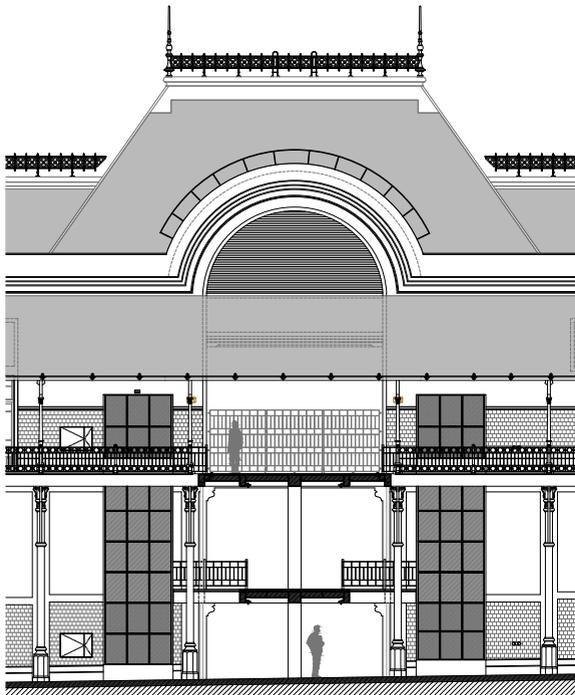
Passadiço e elevadores (desenho de projecto - 2016).
